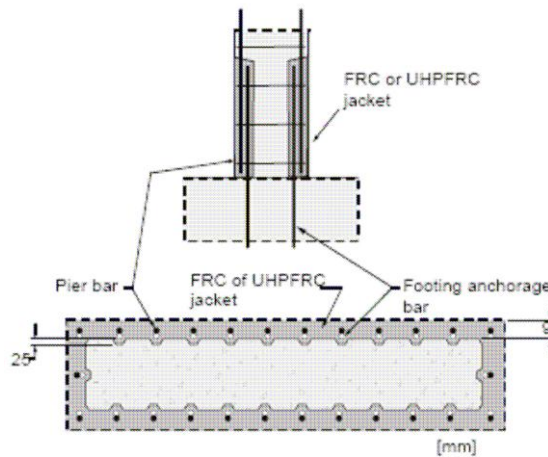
5 : Chemisage béton de poteaux de section rectangulaire ([Priestley et al., 1996]).
